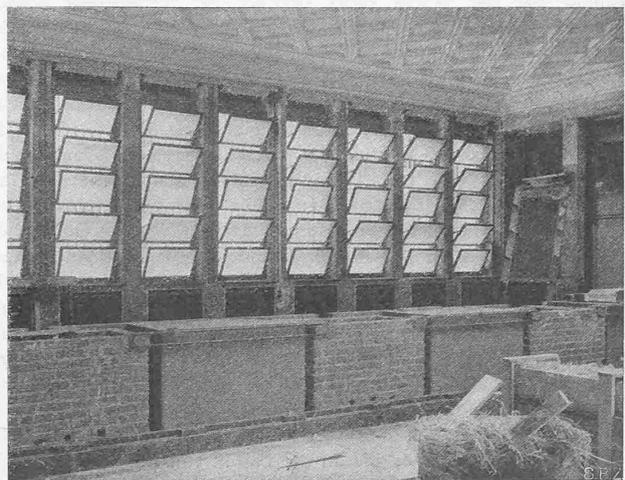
Kassentisch mit eingebauten Kassenschränken (im Bau).
